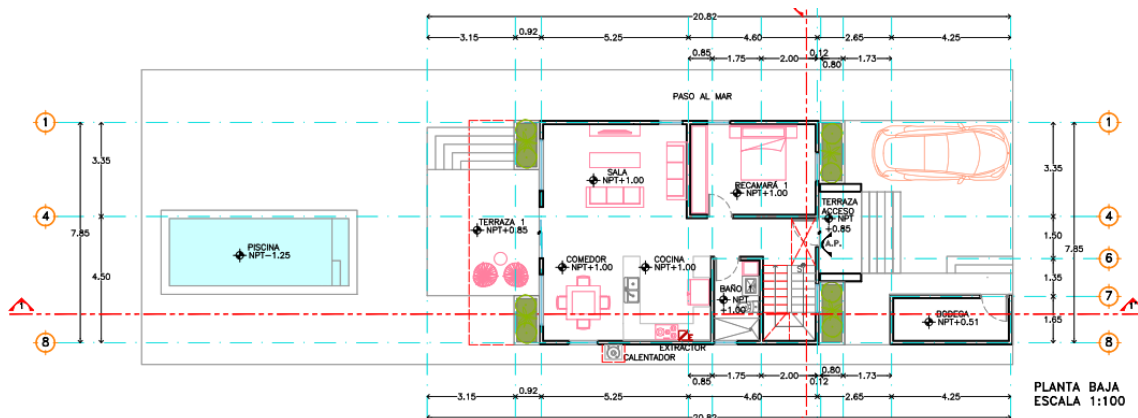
Plano arquitectónico con vista de planta baja. Como se puede observar en esta planta se construirá una recámara, sala, comedor, cocina, terraza, bodega y estacionamiento.
